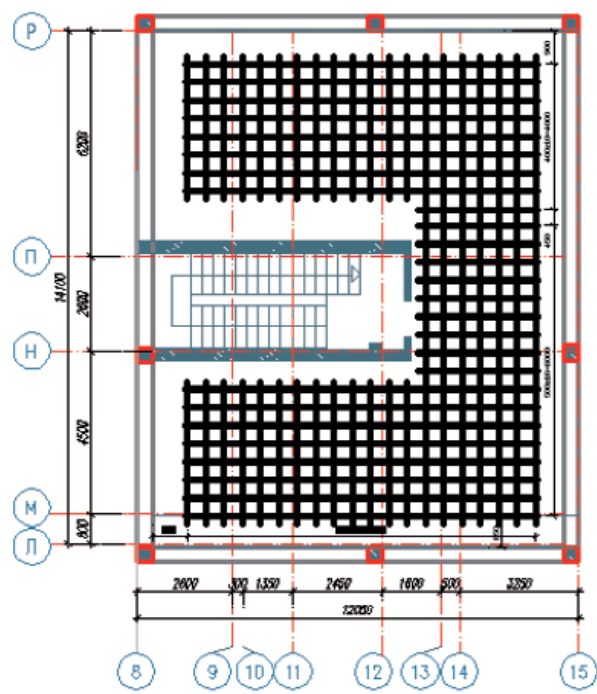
Схема усиления плиты на отм. +22,000 Блока «С» на ул. Горной
